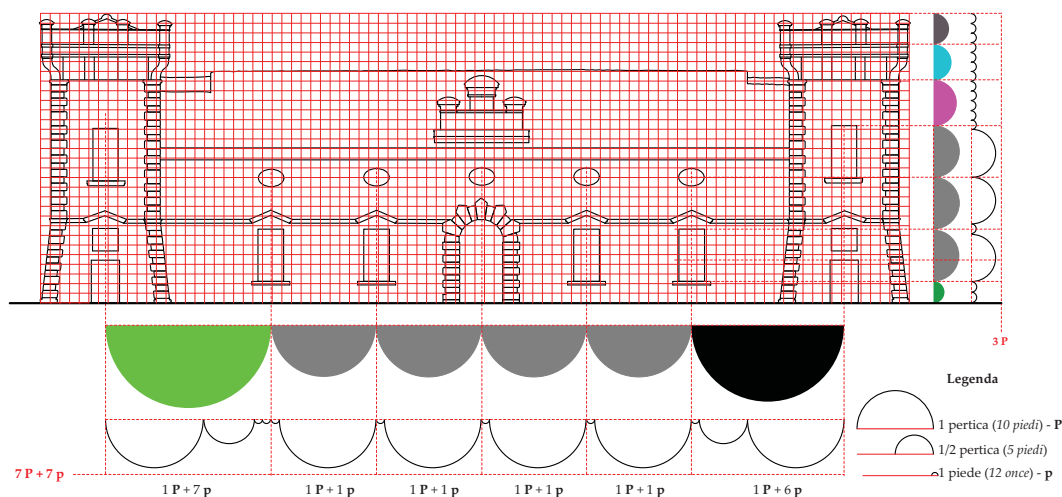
Analisi sulle eurtmie modulari e le corrispondenze rilette attraverso l'unità di misura del tempo, calcolate rispetto alle aperture del prospetto Ovest.
